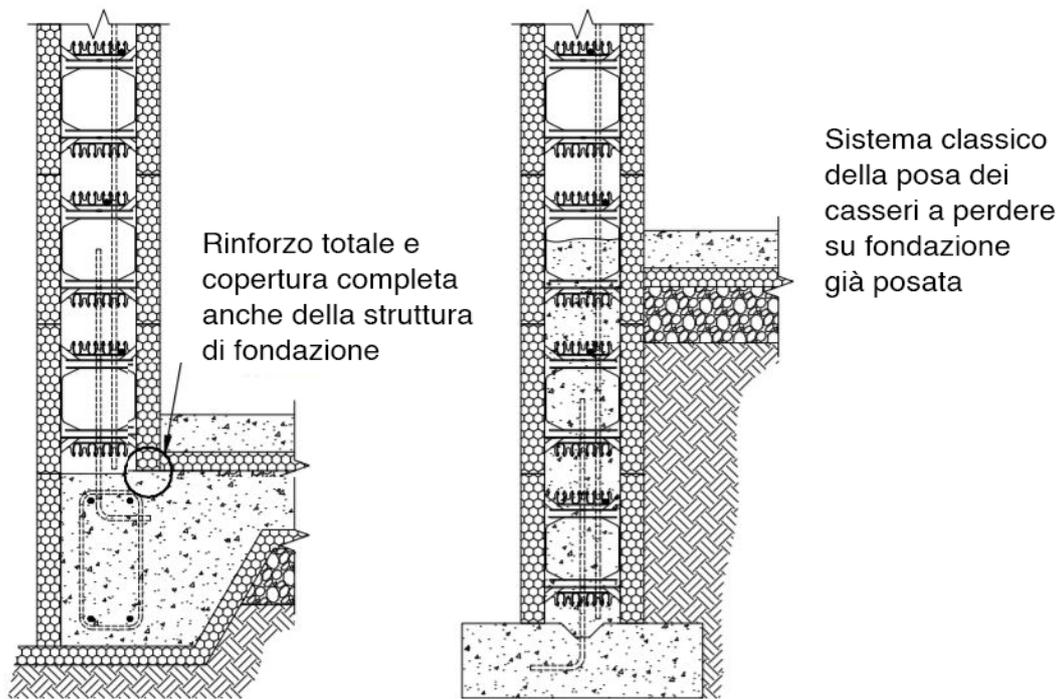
Differenziazione del sistema a cappotto completo di progetto rispetto alla classica posa ICF.
